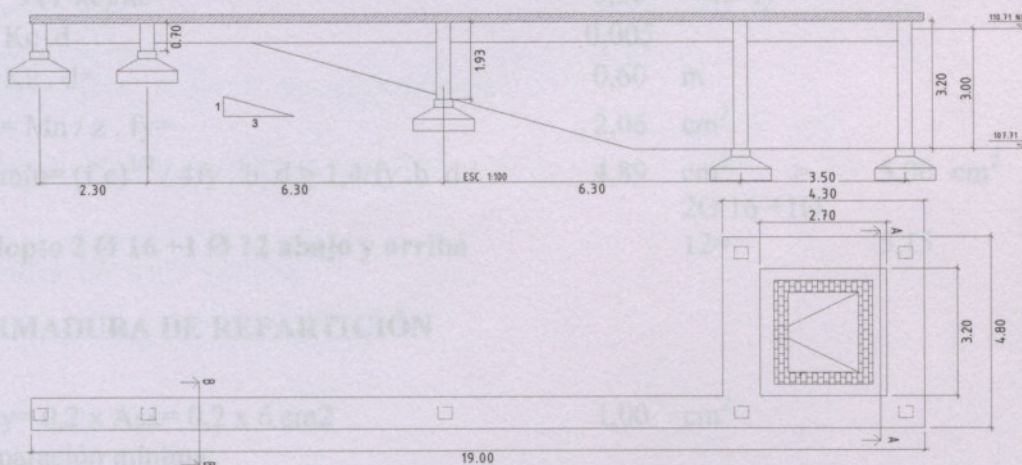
Estructura de las pasarelas de las Lagunas de estabilización.
